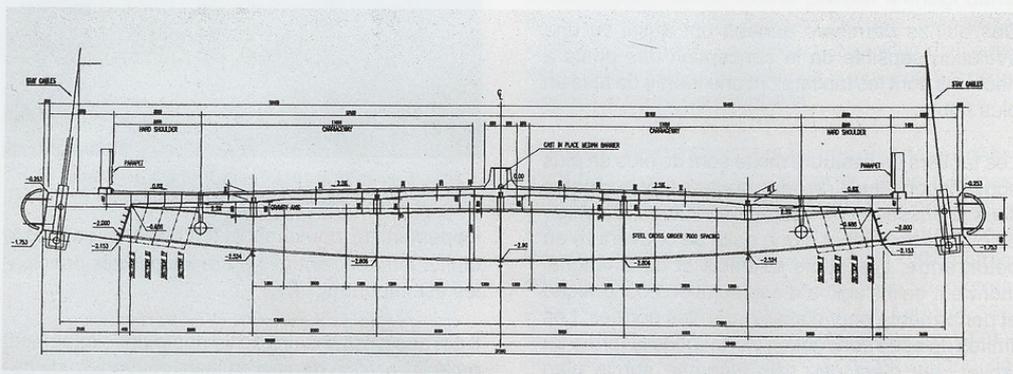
Coupe transversale d'un projet non retenu pour le Pont de Ting Kau.
